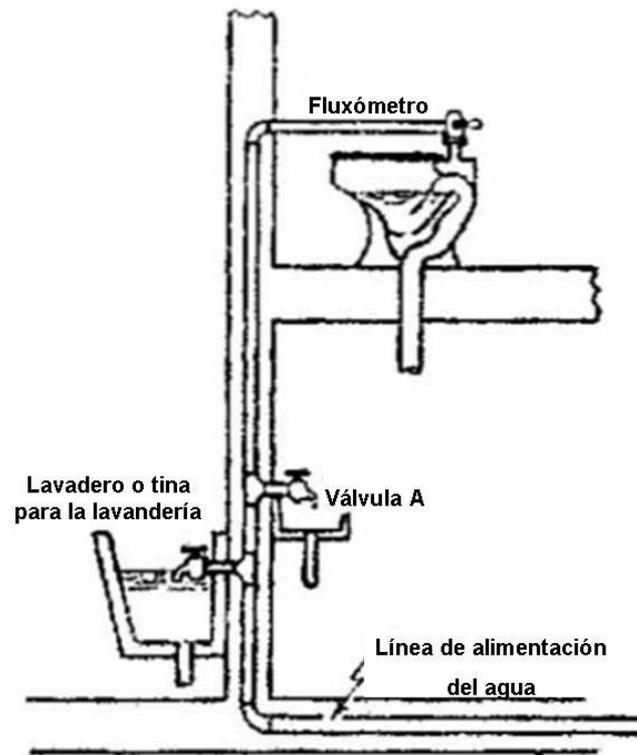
POSIBLE CONEXIÓN CRUZADA.
